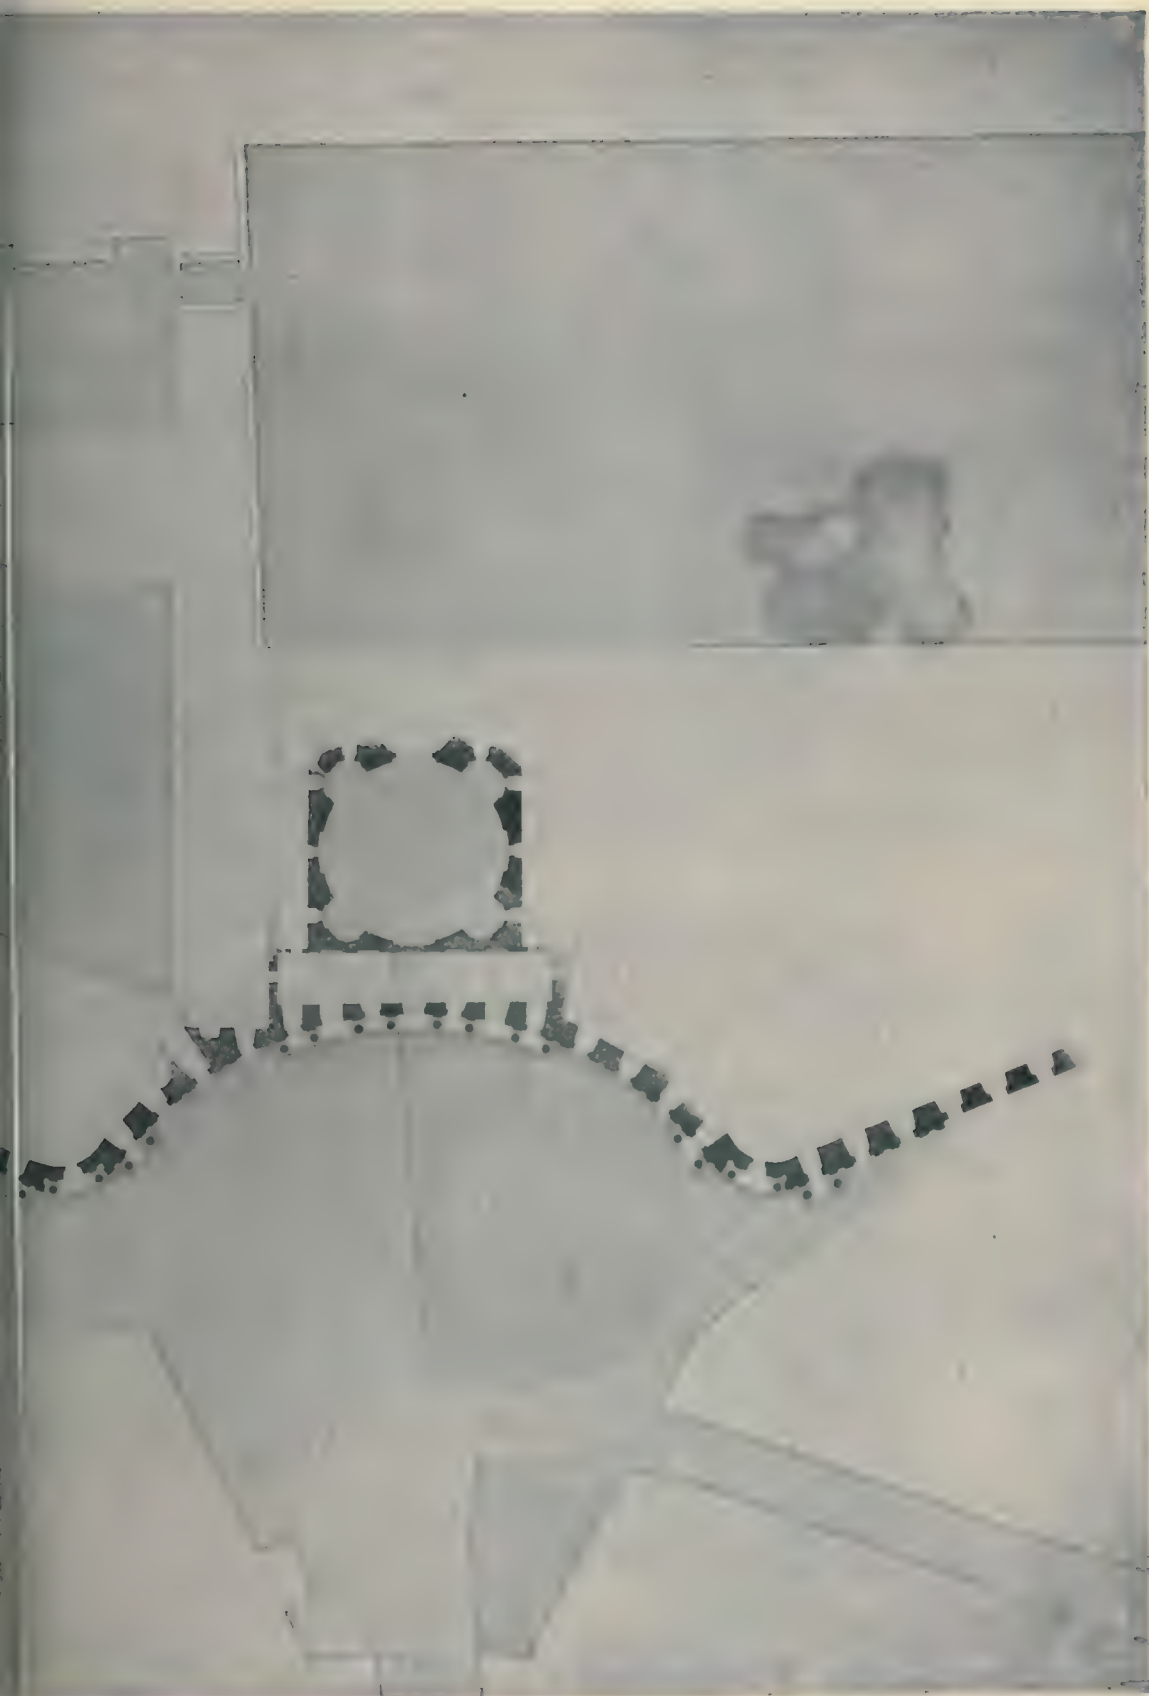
Entwurf (Grundriß des oberen Hauptgeschosses) für den
